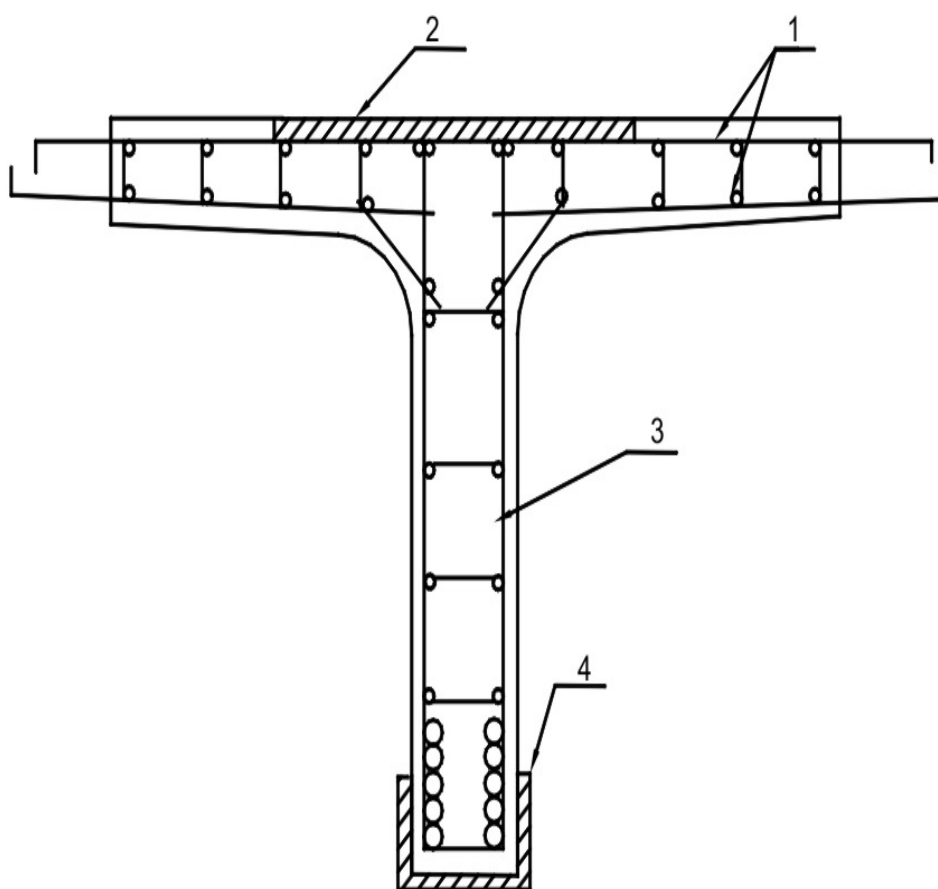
Усиление железобетонной балки приваркой плоского листа к плите и обоймы из швеллера к ребру: 1 – существующая арматура; 2 – лист усиления; 3 – усиливаемая балка; 4 – швеллер (обойма)
